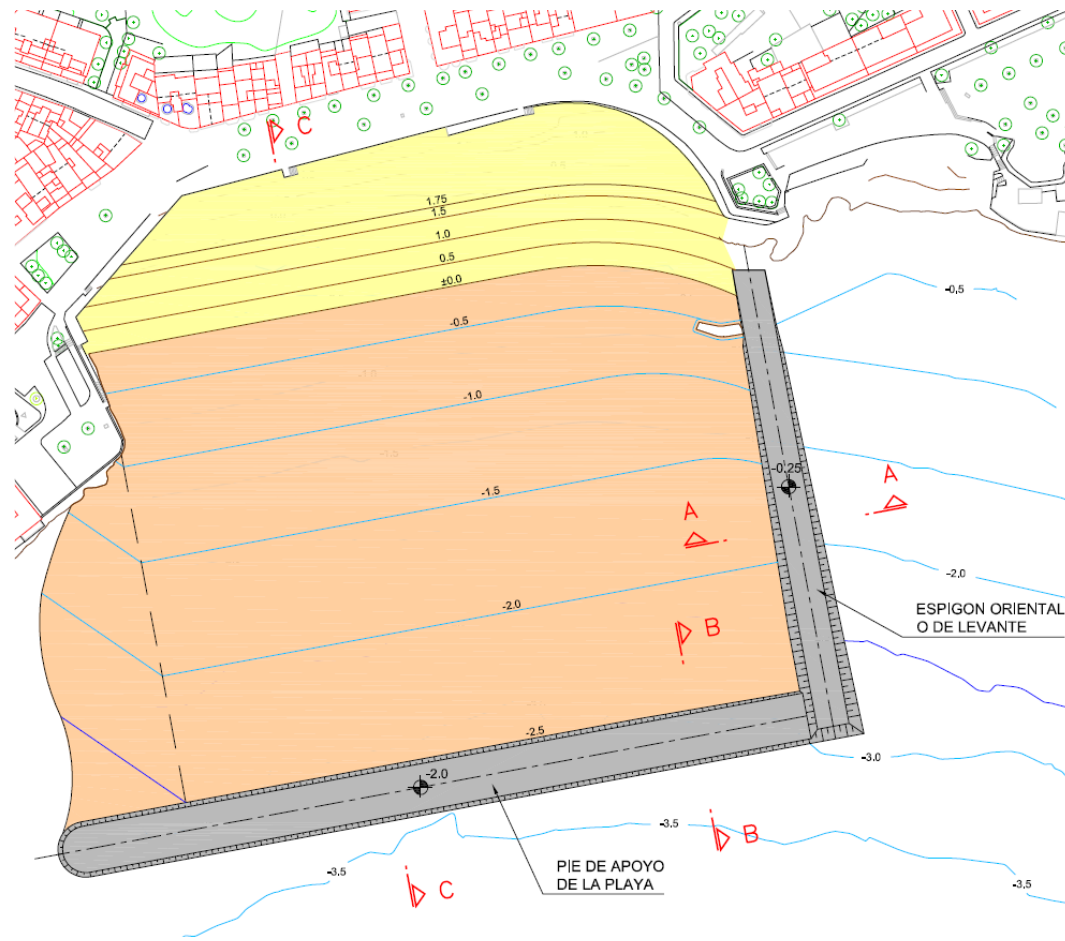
Planta de la Alternativa 2. (Fuente: Elaboración propia)
